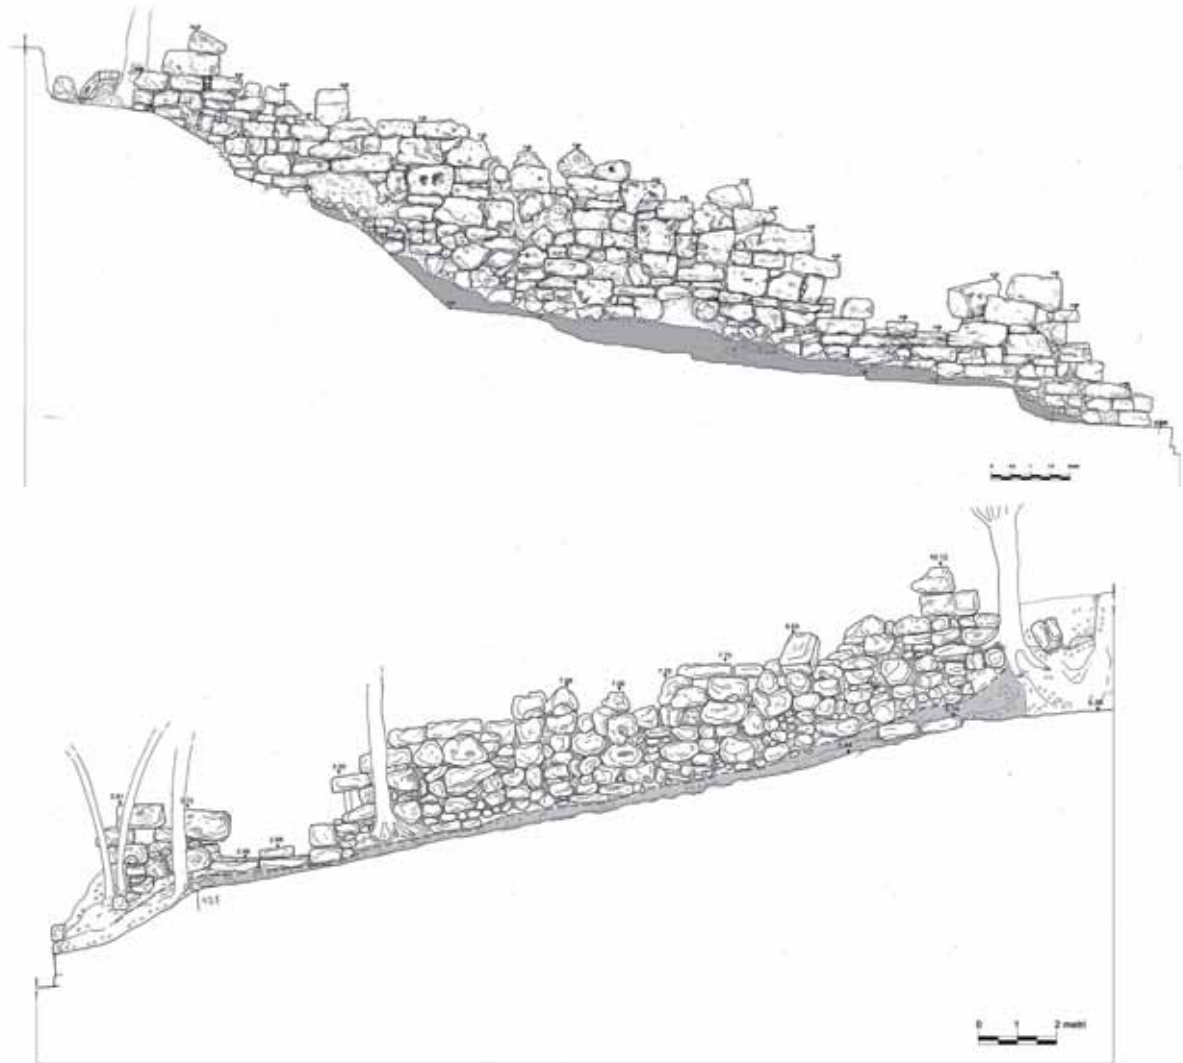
a, b - Muro località Sani'Andrea. a) prospetto principale b) prospetto tergale (M.R. Galanti e R. Sabelli)
